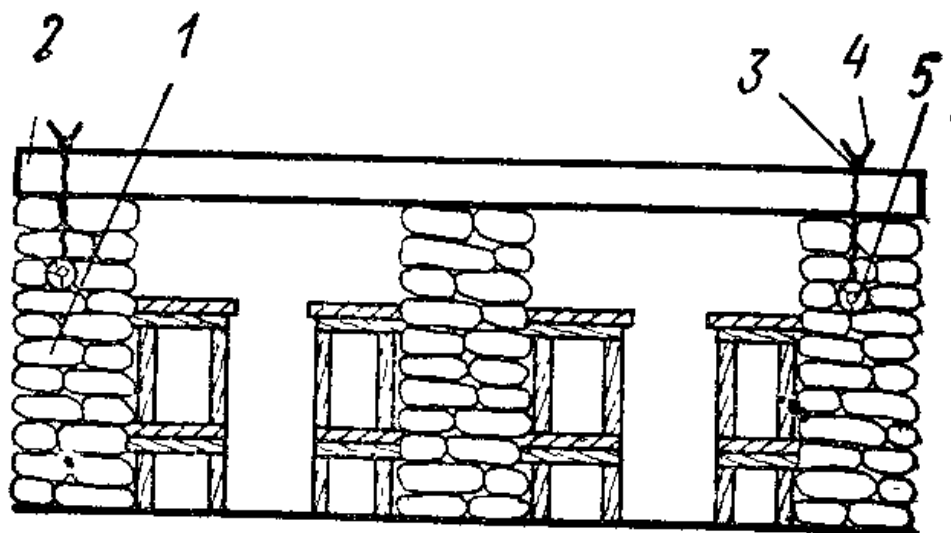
Поперечный разрез убежища со стенами из грунтонабивных мешков, где
